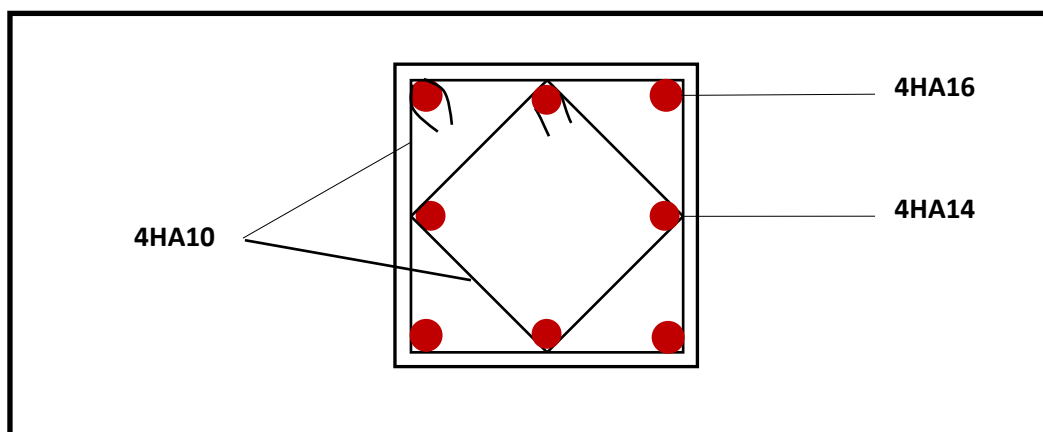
Schéma de ferrailage du poteau 40x40.
